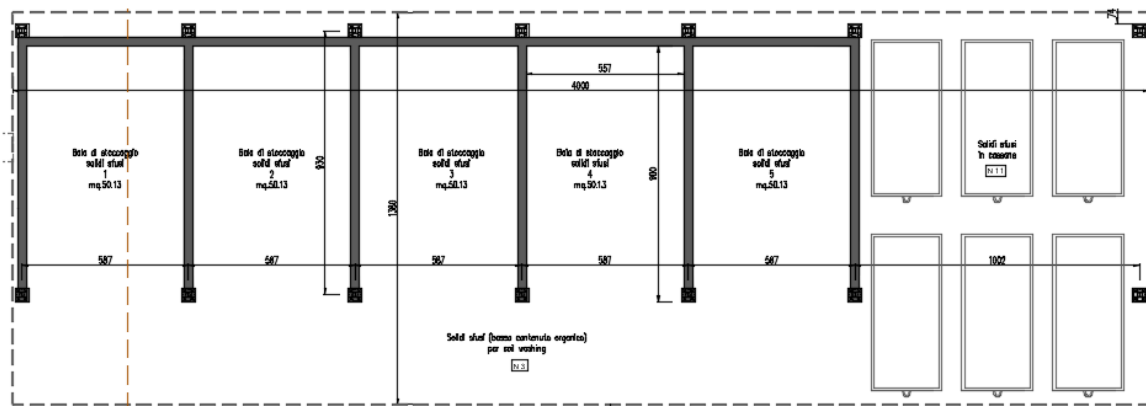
pianta tettoia solidi sfusi (N3-N11)
